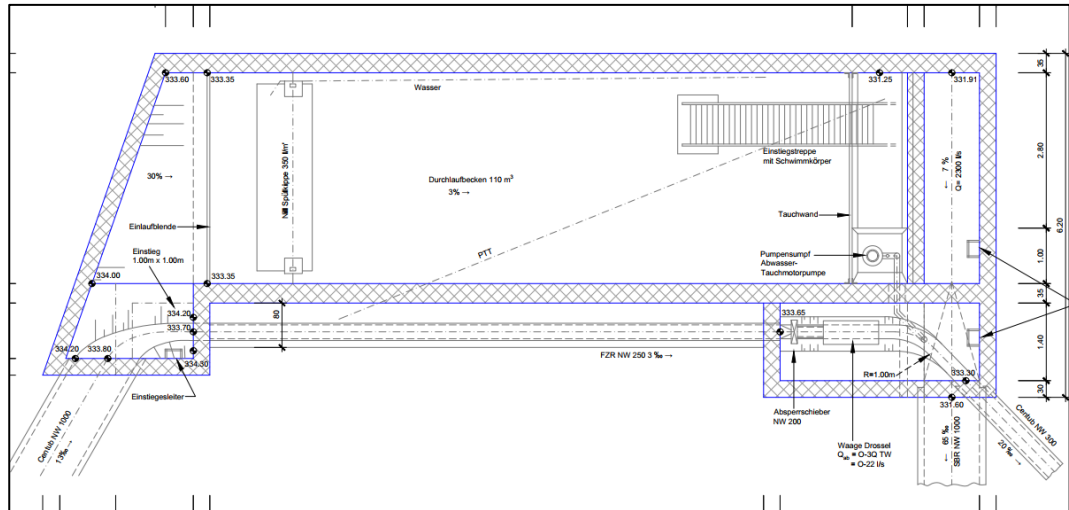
RÜB Ländistrasse, Grundriss
